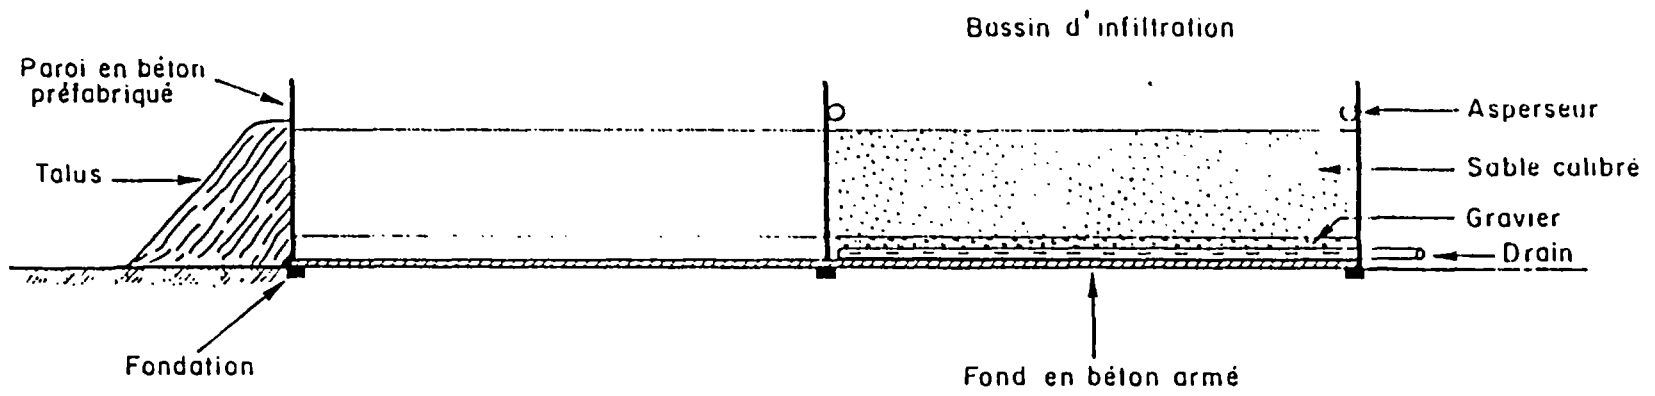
COUPE LONGITUDINALE DE LA FILIERE D'EPURATION
